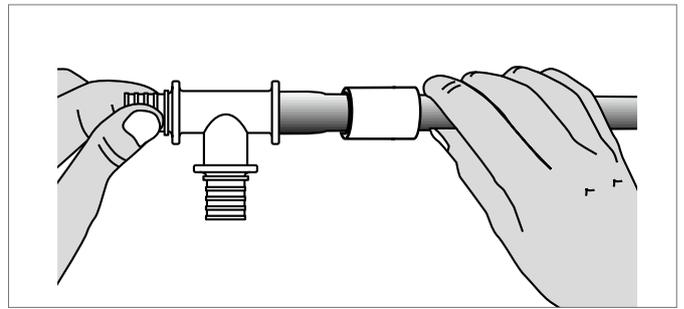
Fitting in das aufgeweitete Rohr stecken
